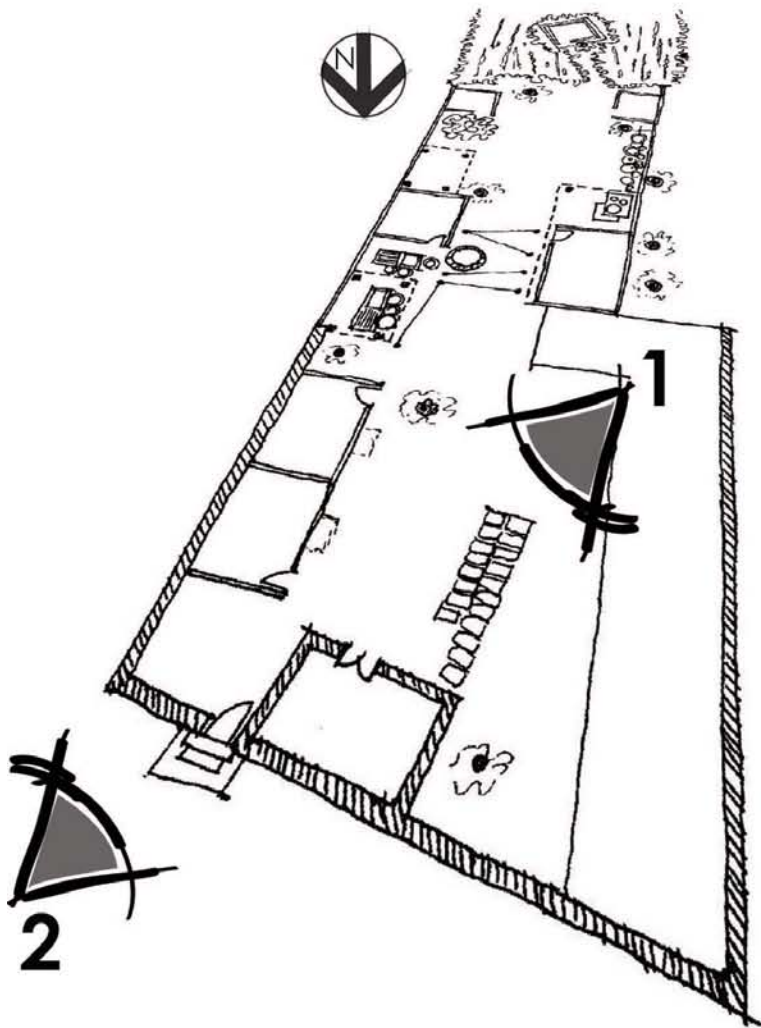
Planta Arquitectónica de la configuración espacial en la vivienda de la Familia García Ramírez.
